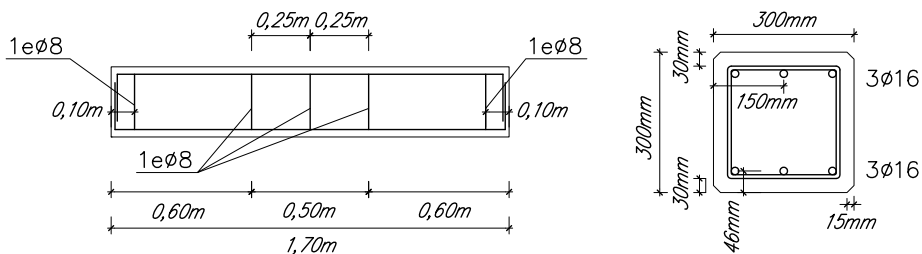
Detalle de la geometría y del refuerzo de las vigas construidas y ensayadas: despiece armaduras longitudinal y transversal (izquierda) y sección transversal (derecha).
